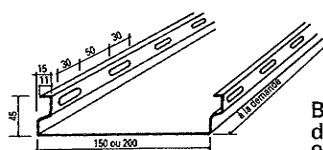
Plancher et plafond « Cofarma ». Bac standard en tôle d'acier galvanisé de 8/10 mm.
